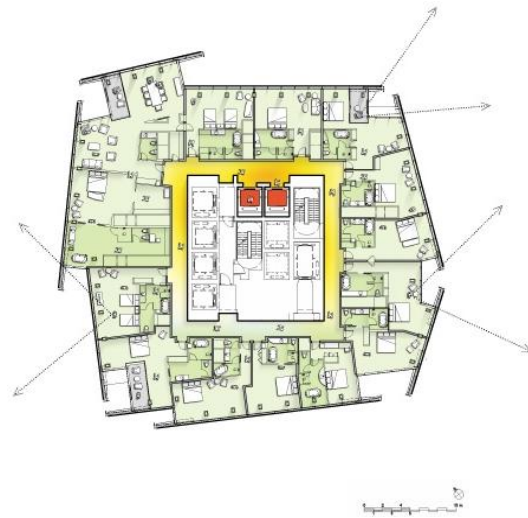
plan de 39<sup>ème</sup> étage (hotel)
